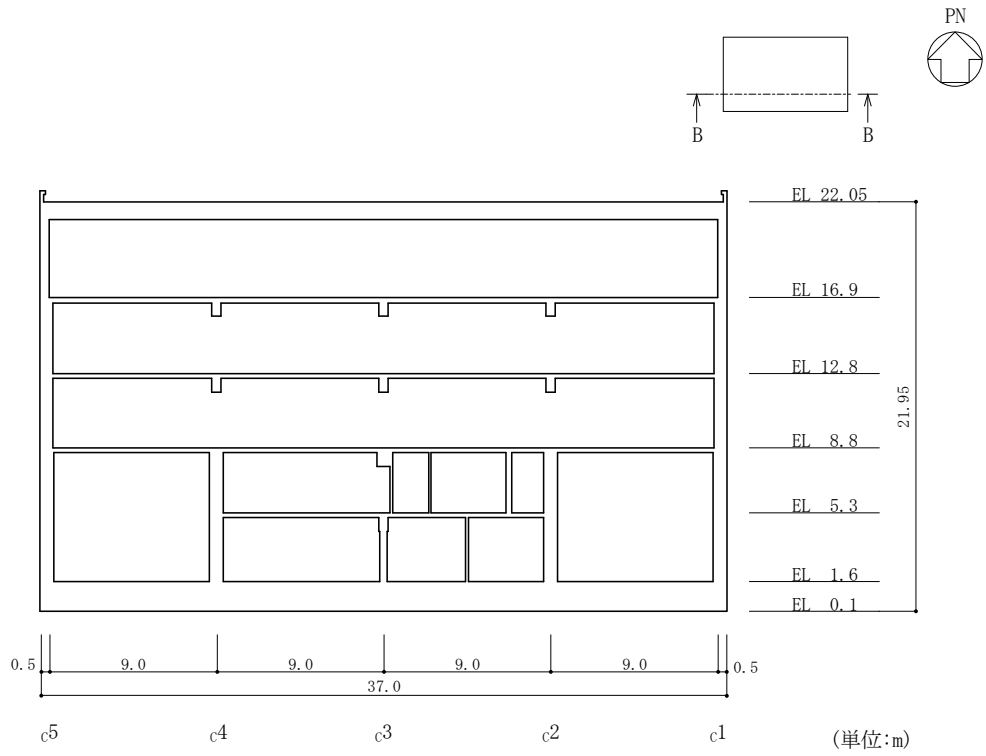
(2) 制御室建物の概略断面図 (B-B 断面, EW 方向)
